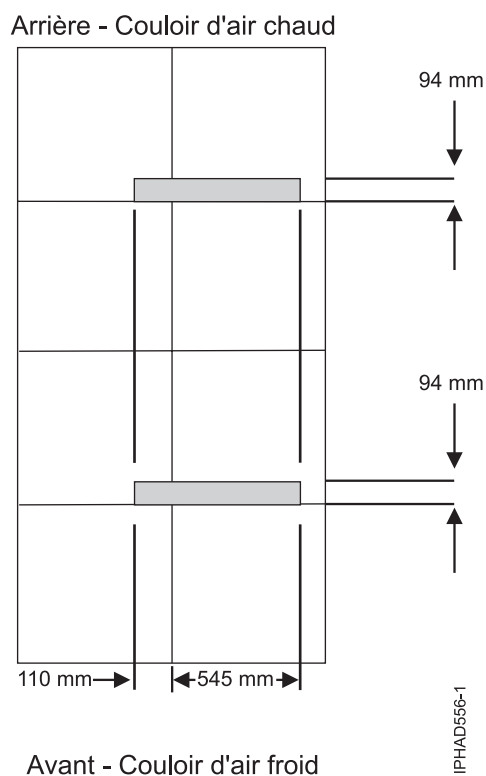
Positionnement des découpes de câble pour dalles de plancher de 610 mm
